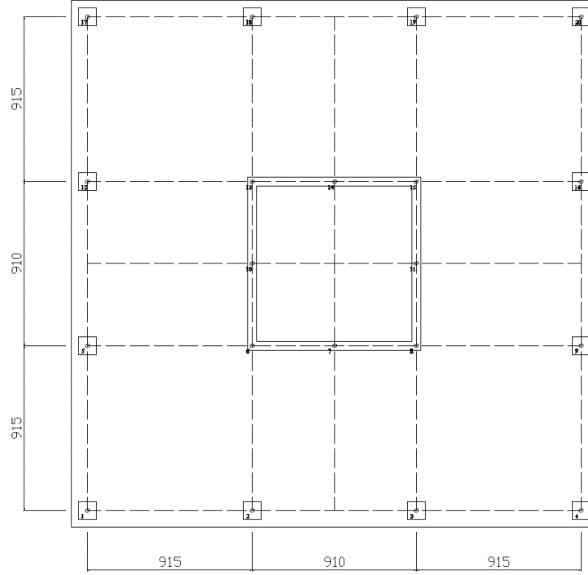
Gedikbulak Yapısı kolon boyutları ve donatı detayları.
